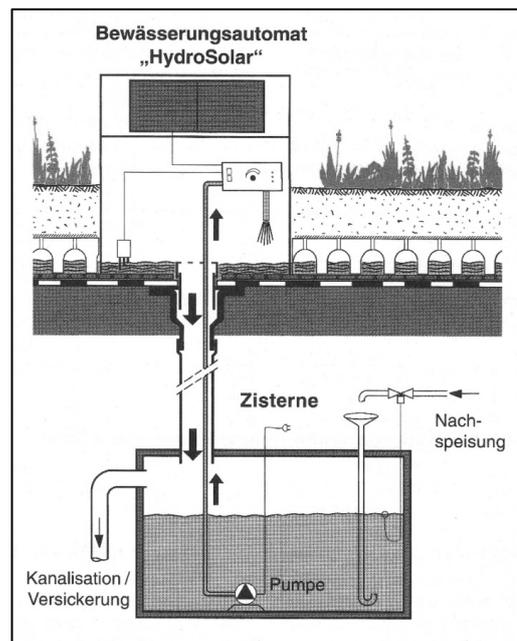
Schema Bewässerungsautomat, Quelle: Zink, Das grüne Dach Standardwerk für Planung und Ausführung genutzter Dachflächen; Planungshilfe, Unterensingen 1998, S.10.
